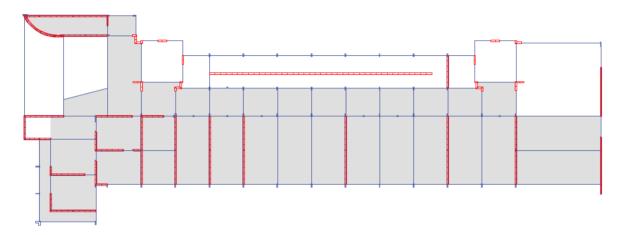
Planta primer piso, Escuela Unión Latinoamericana Edificio 1.
